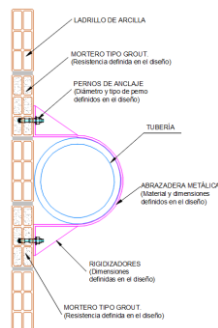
Tubería adosada a muros en ladrillo de arcilla – Sección
